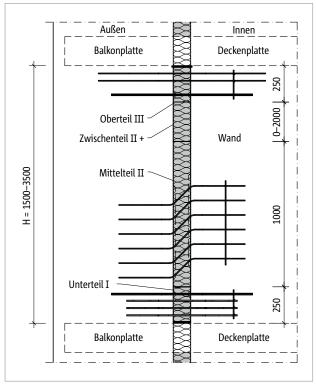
Schöck Isokorb® XT Typ W: Grundriss; Balkonkonstruktion mit wärmegedämmten tragenden Wandscheiben
